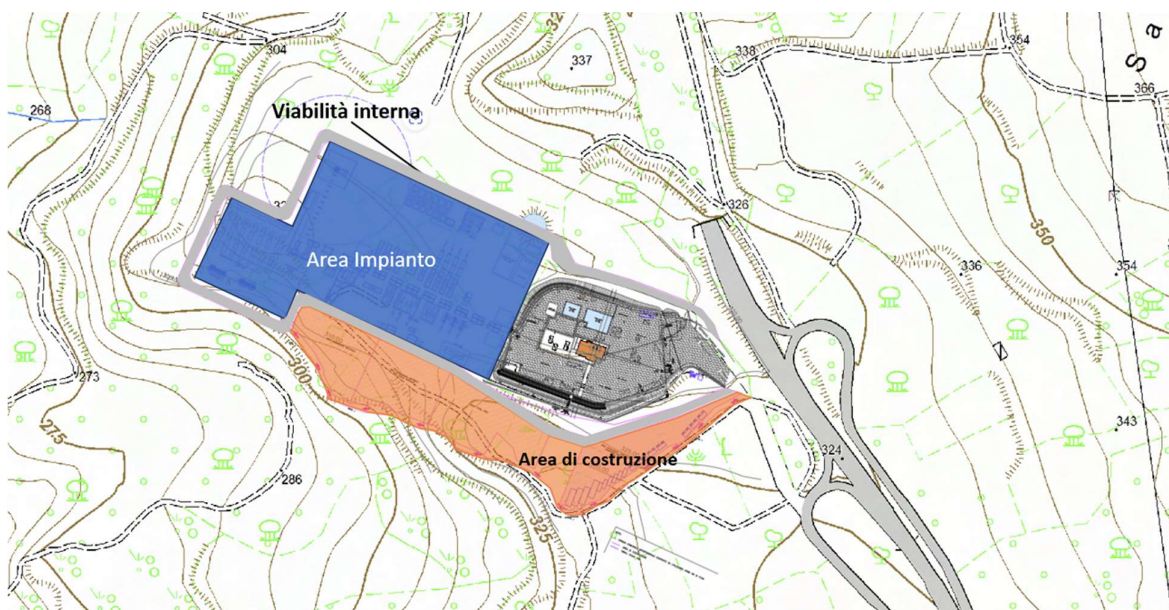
INDIVIDUAZIONE DELLE AREE DI PROGETTO
